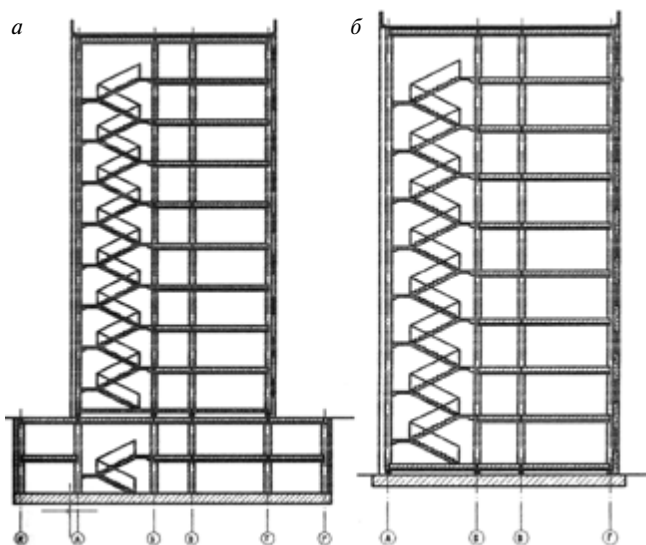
Конструктивные схемы здания: а – здание с подземным гаражом; б – здание без гаража
